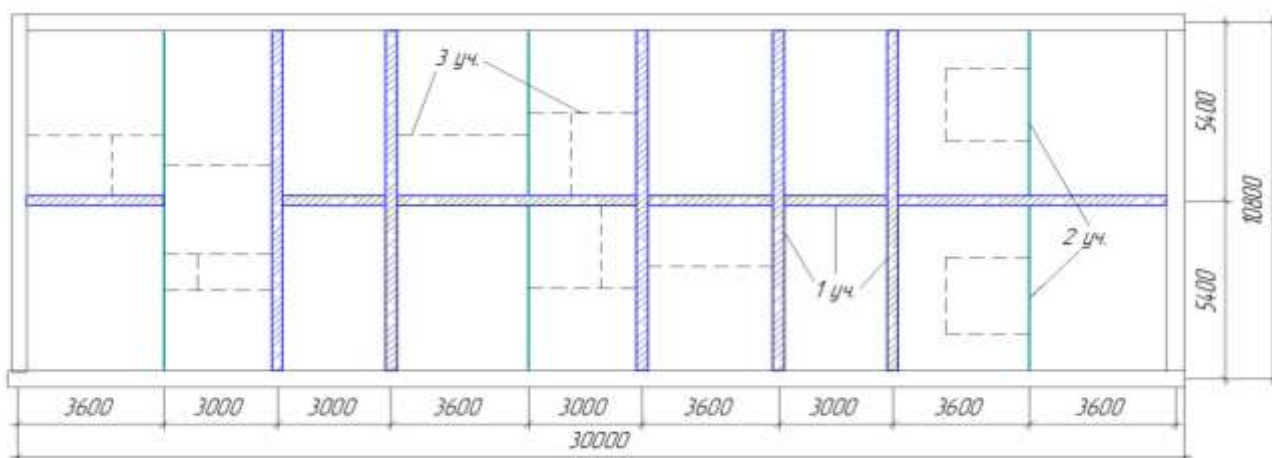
План здания, для всех вариантов контрольной работы №1
